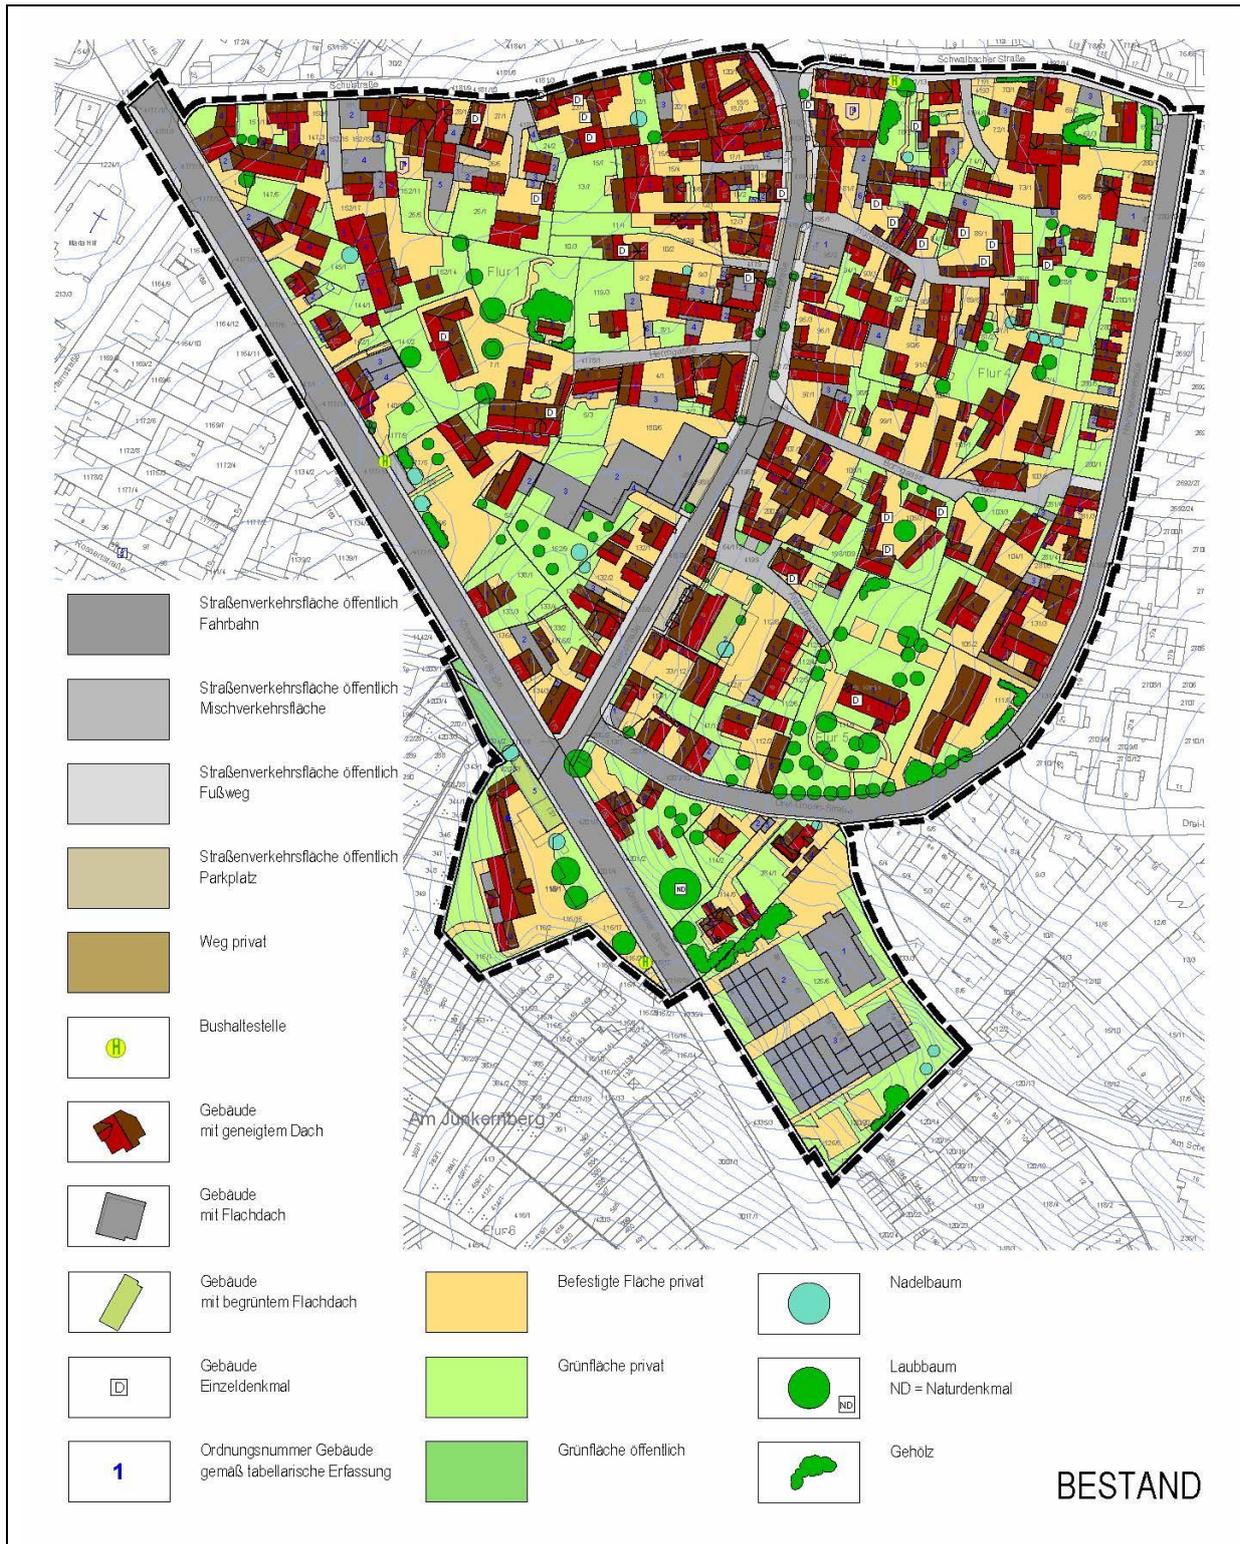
Bestandsplan Baugebiet, o.M., Planergruppe ASL
